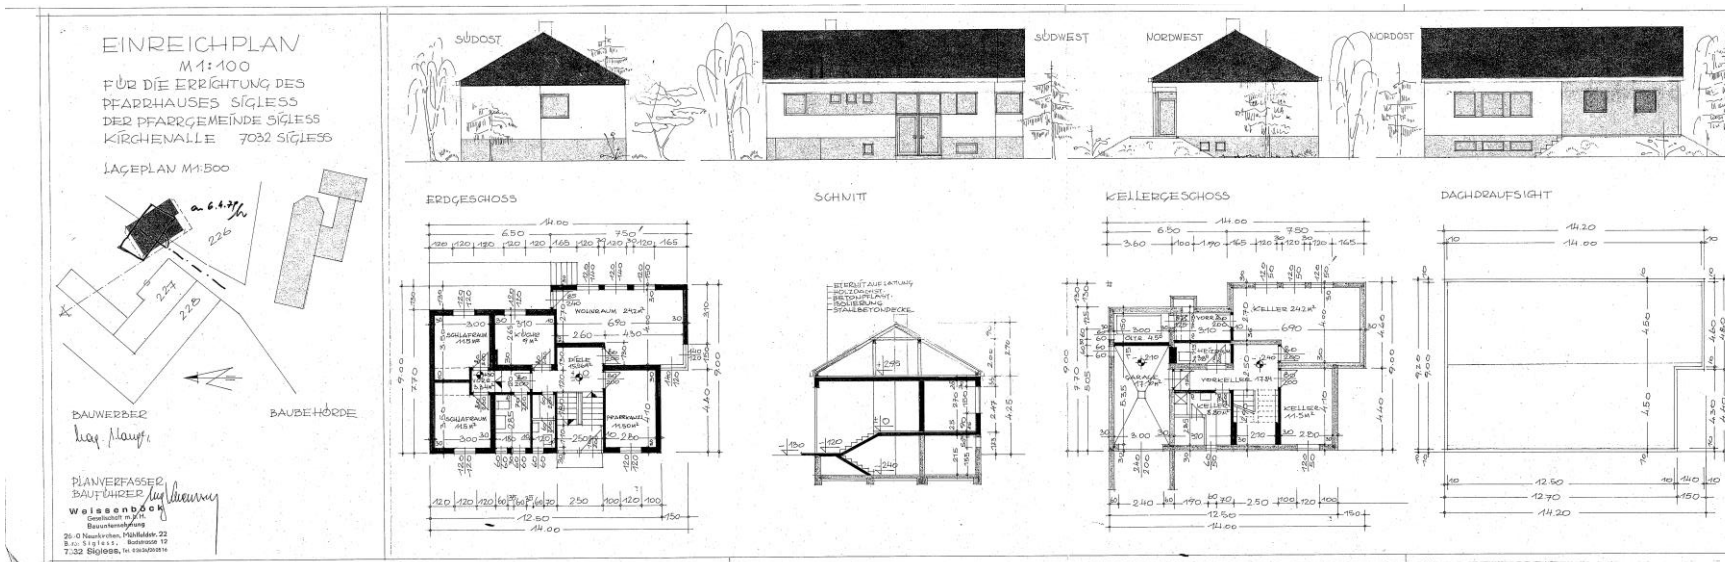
Einreichplan Pfarrhaus Sigleß.
